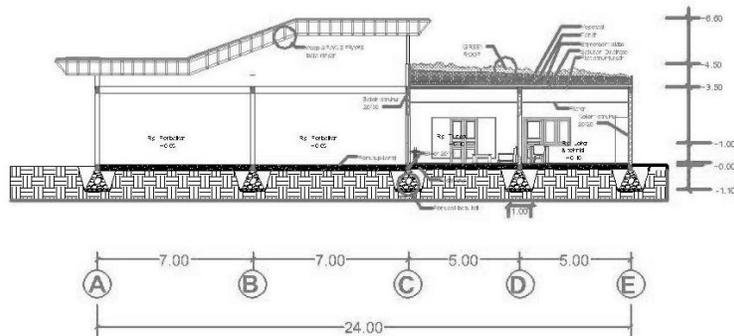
Potongan Bangunan Skematik Resto & Lounge
